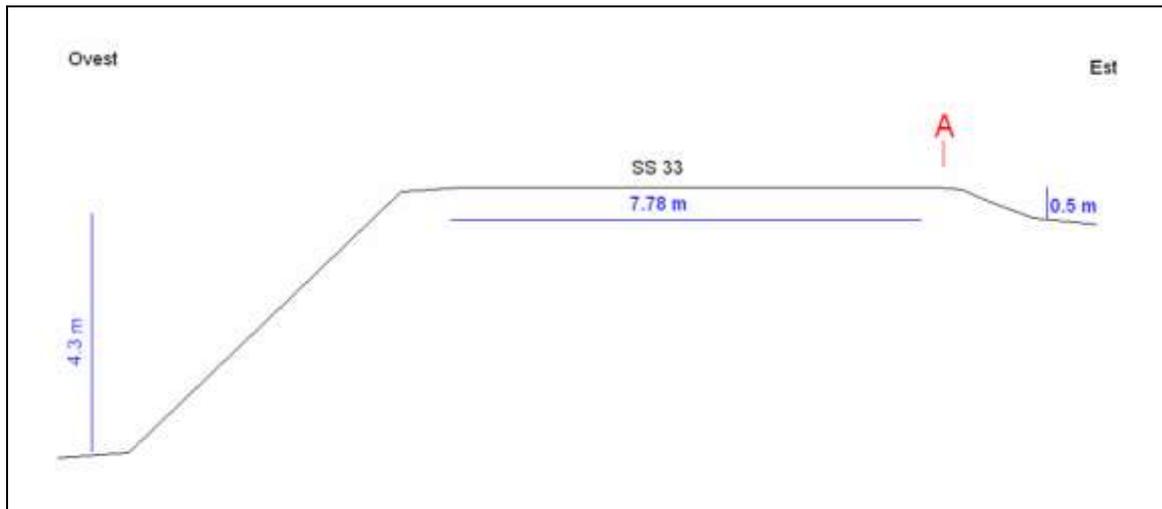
Sezione schematica del tratto stradale di interesse (SS 33)
